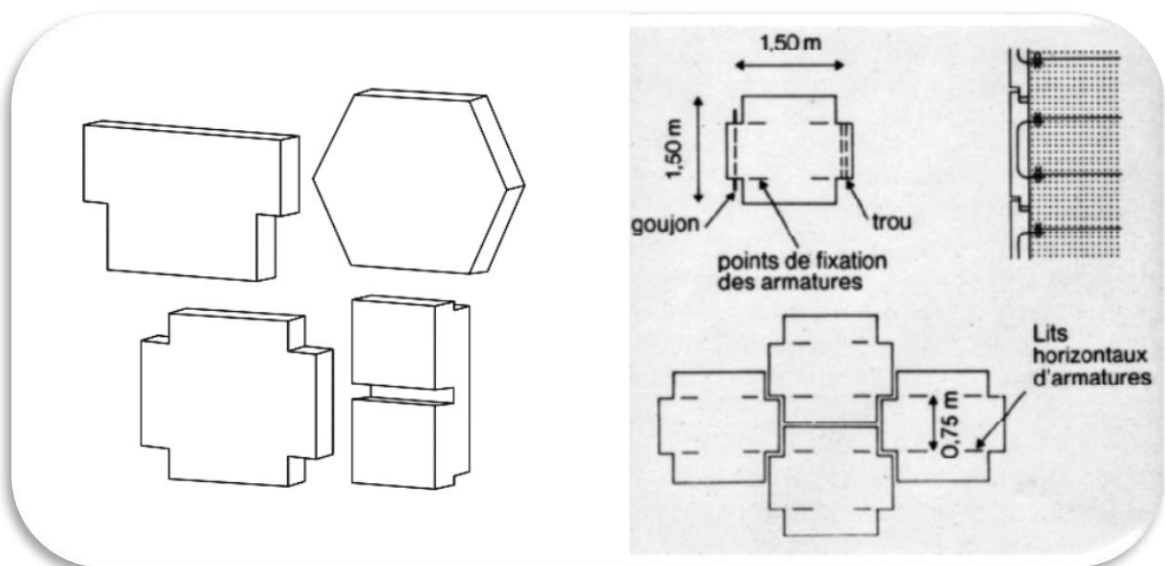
Panneaux de hauteur partielle (Terre Armée)
